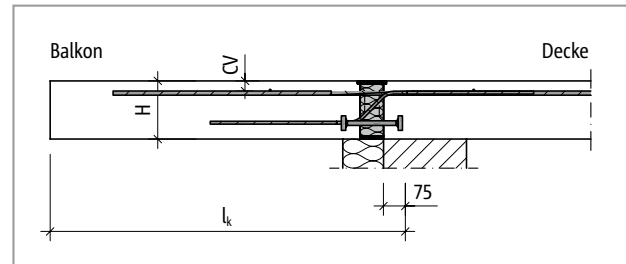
Schöck Isokorb® T Typ K-M12: Statisches System
